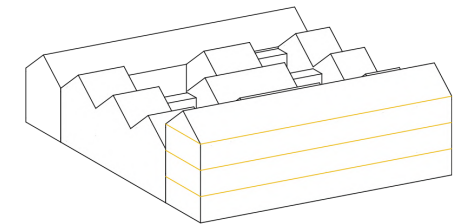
Kopfbauten schließen Hofhausblöcke ab
